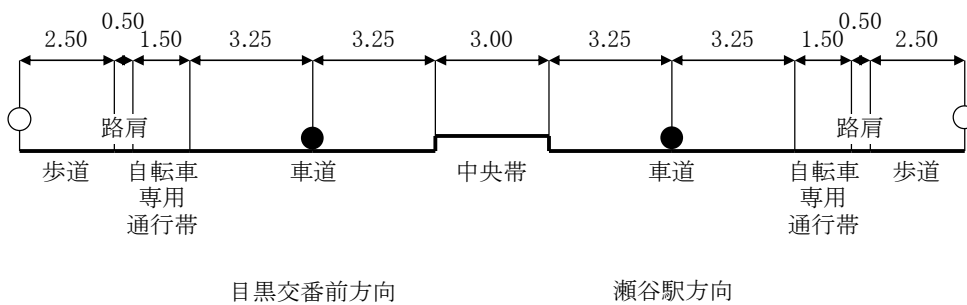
(4) 道路断面及び音源の位置 (No. 4)
